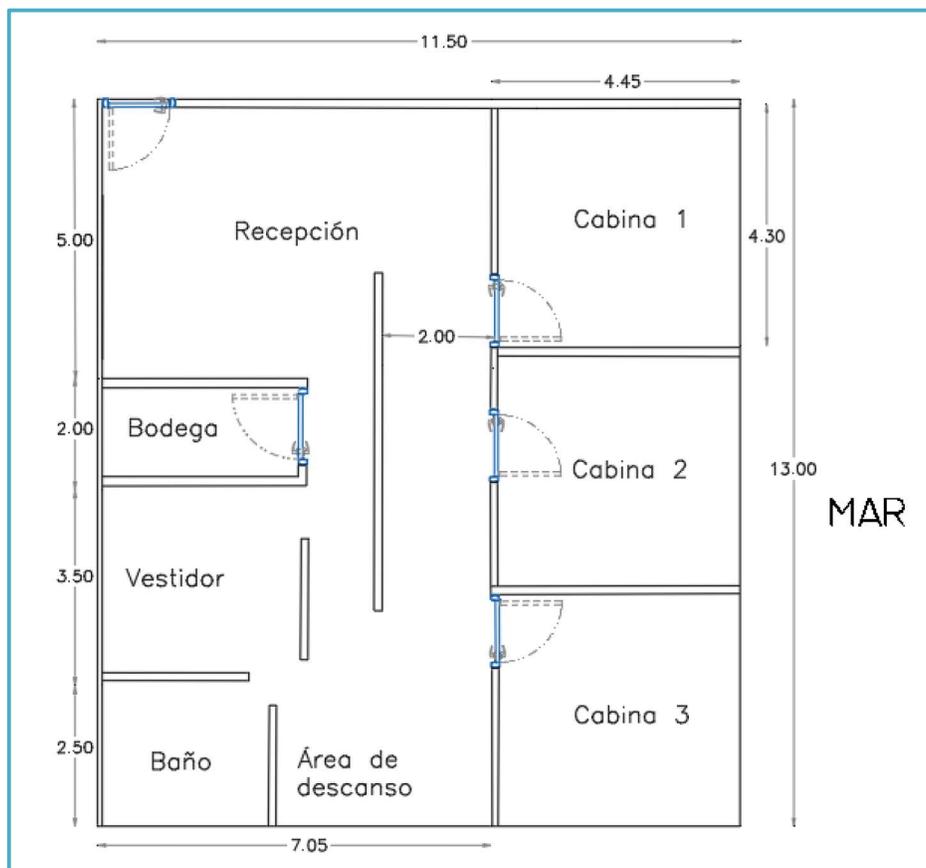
Vista en planta de instalaciones para servicios tipo SPA.
